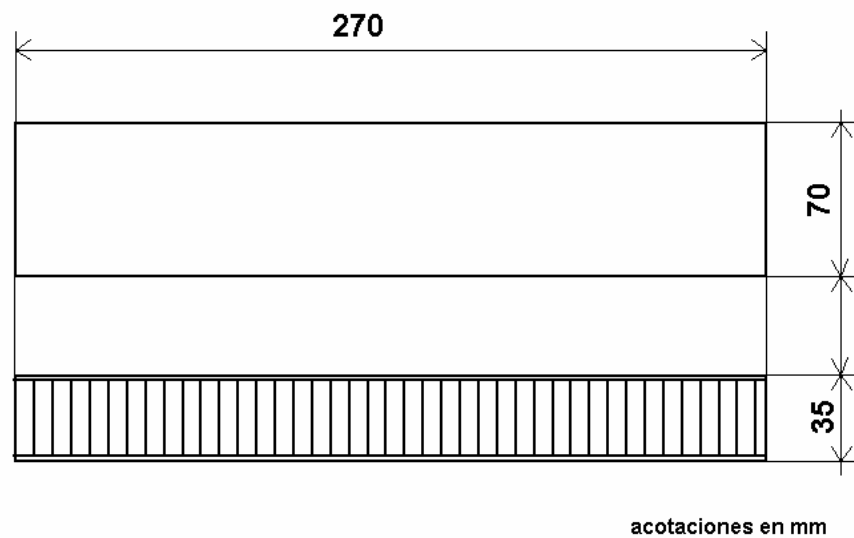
Dimensiones de la probeta para ensayos de flexión y fatiga
